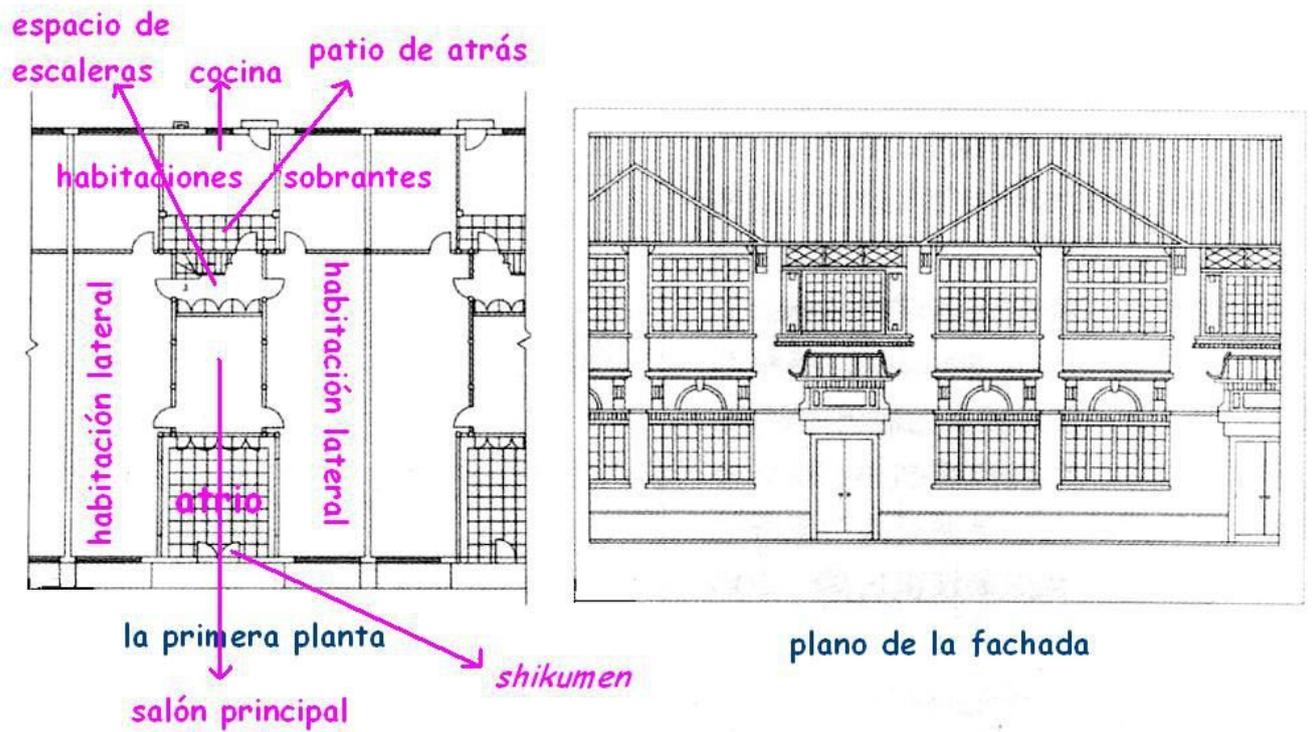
Planta y fachada de la unidad del “lilong de Huile”
